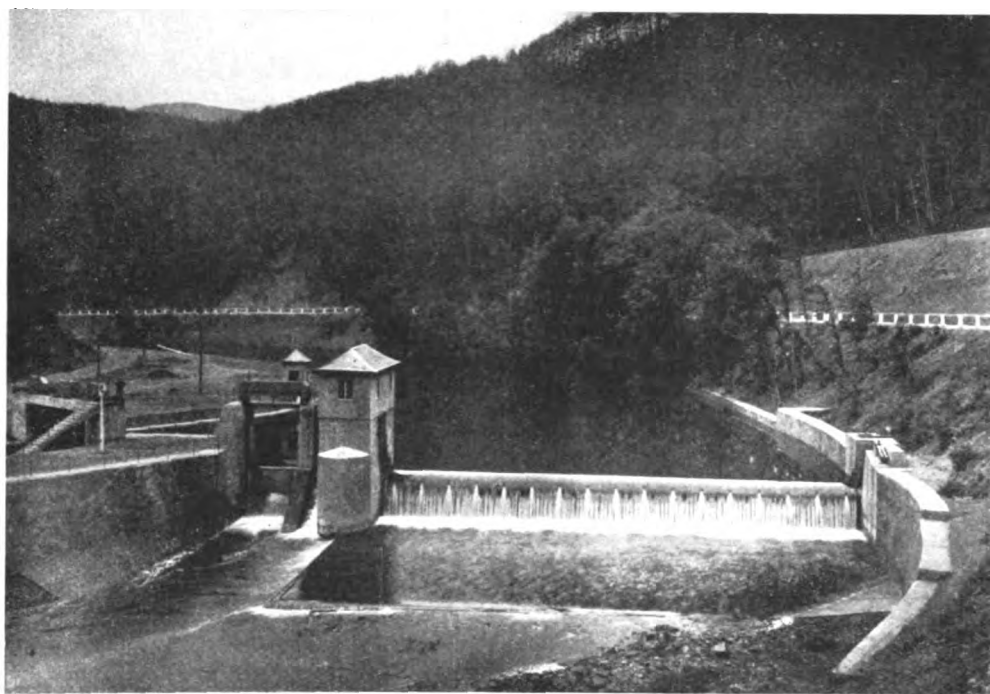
Walzenwehr, Fischpaff, Grundablaß, Kanaleinlaufschütze mit Wehr und Pegelhaus.
